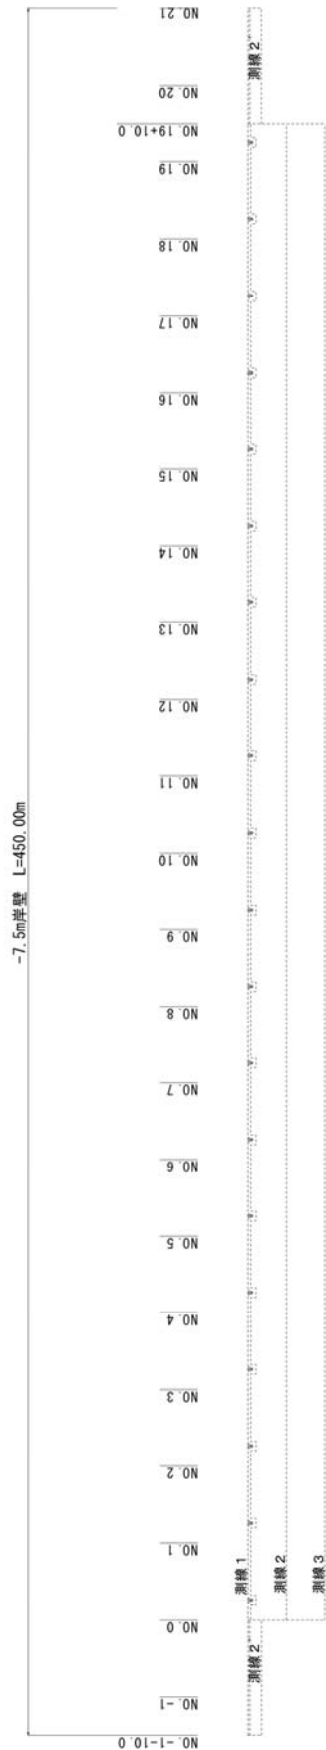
(b) 香椎パークポート地区-7.5m岸壁の被災状況平面図②
